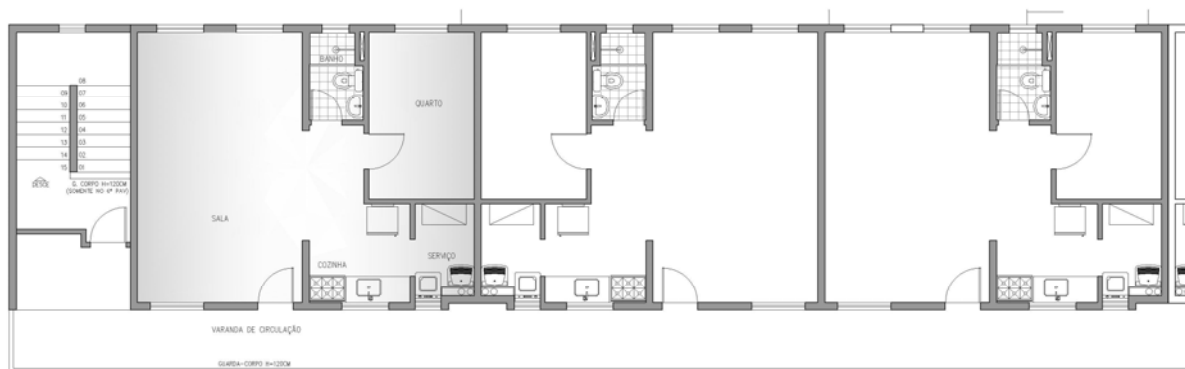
Planta unidade habitacional – Seqüência típica do pavimento
